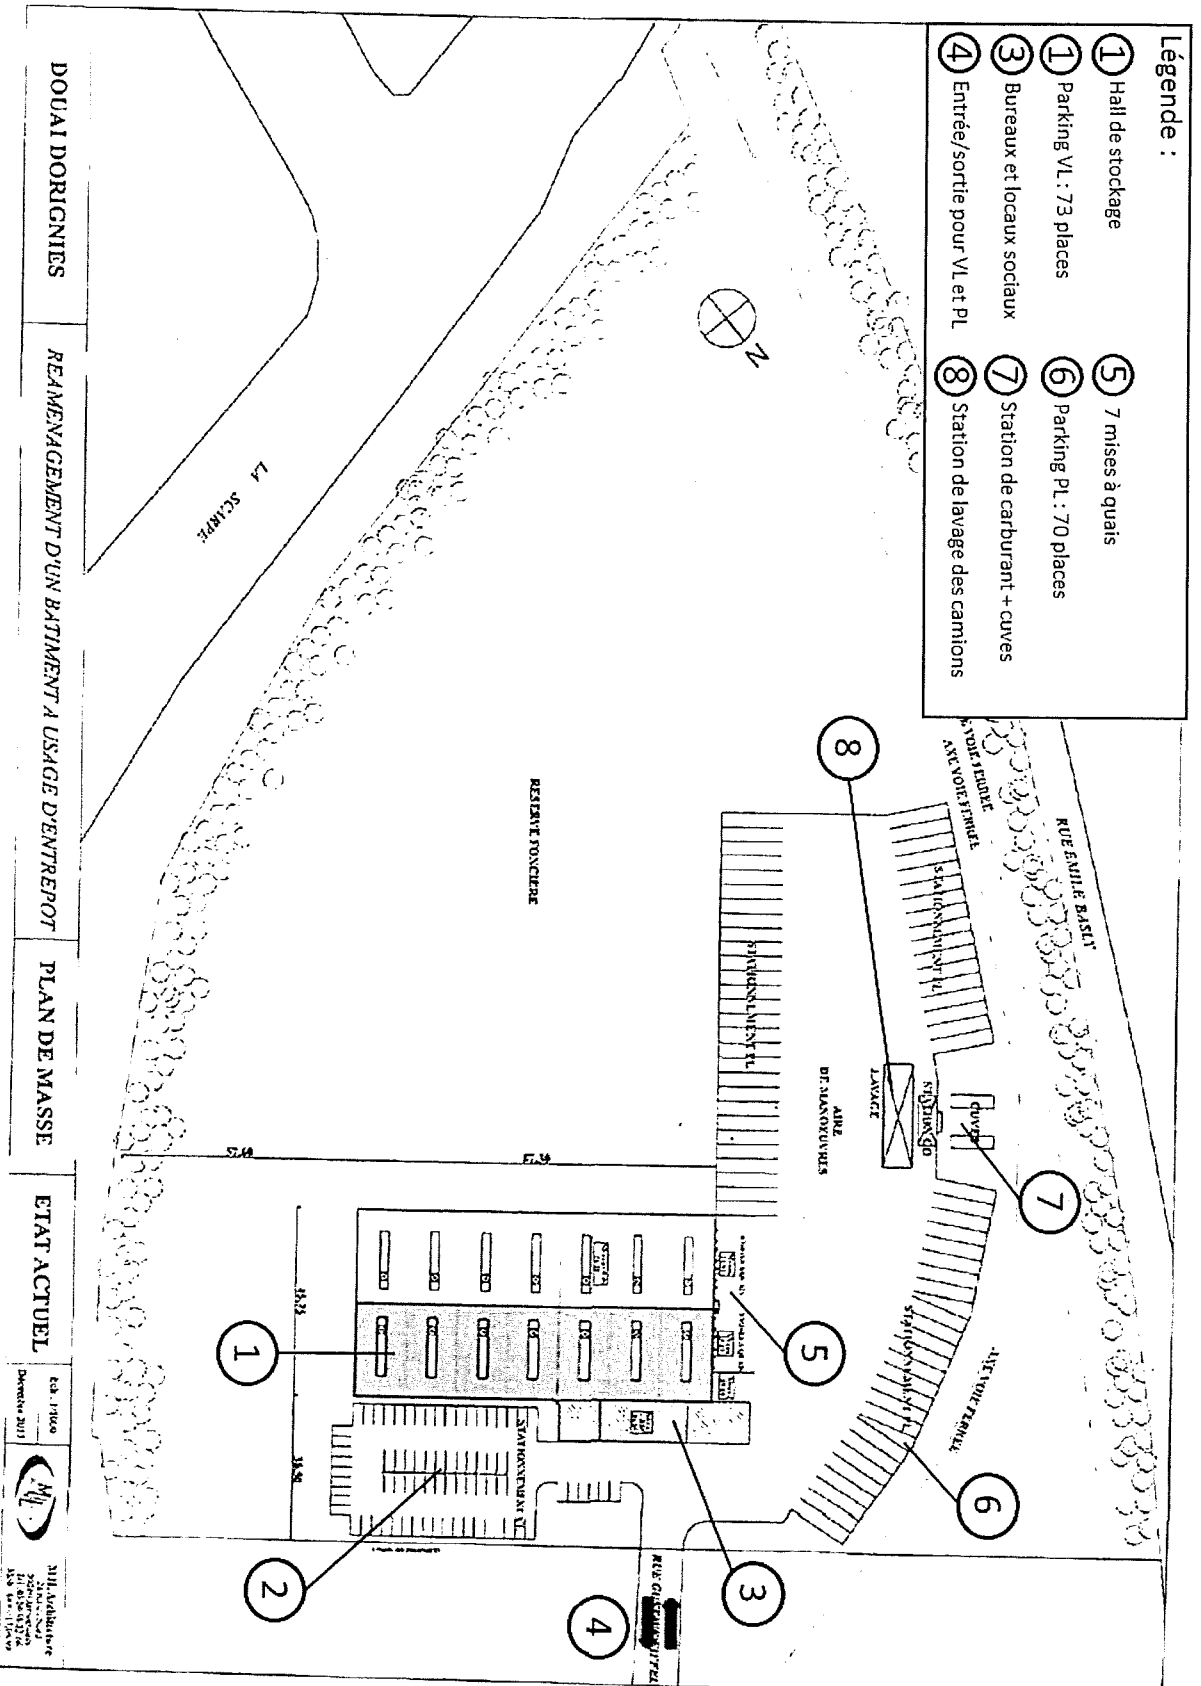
Plan de masse actuel du site - Source : MUL Architecture
